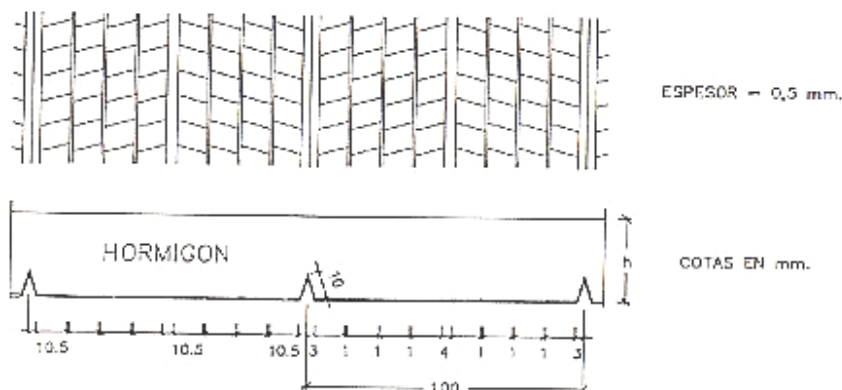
Sección del sistema de losas con armadura metálica con celdillas autoportante.
